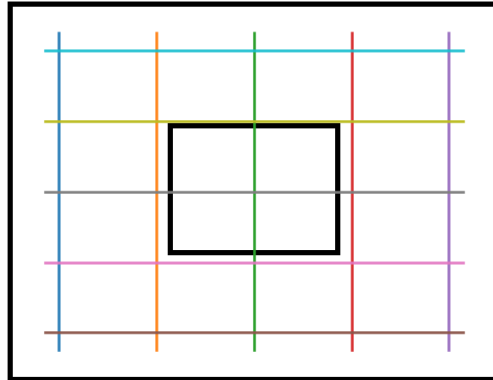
Схема розташування нижньої арматурної сітки фундаменту
